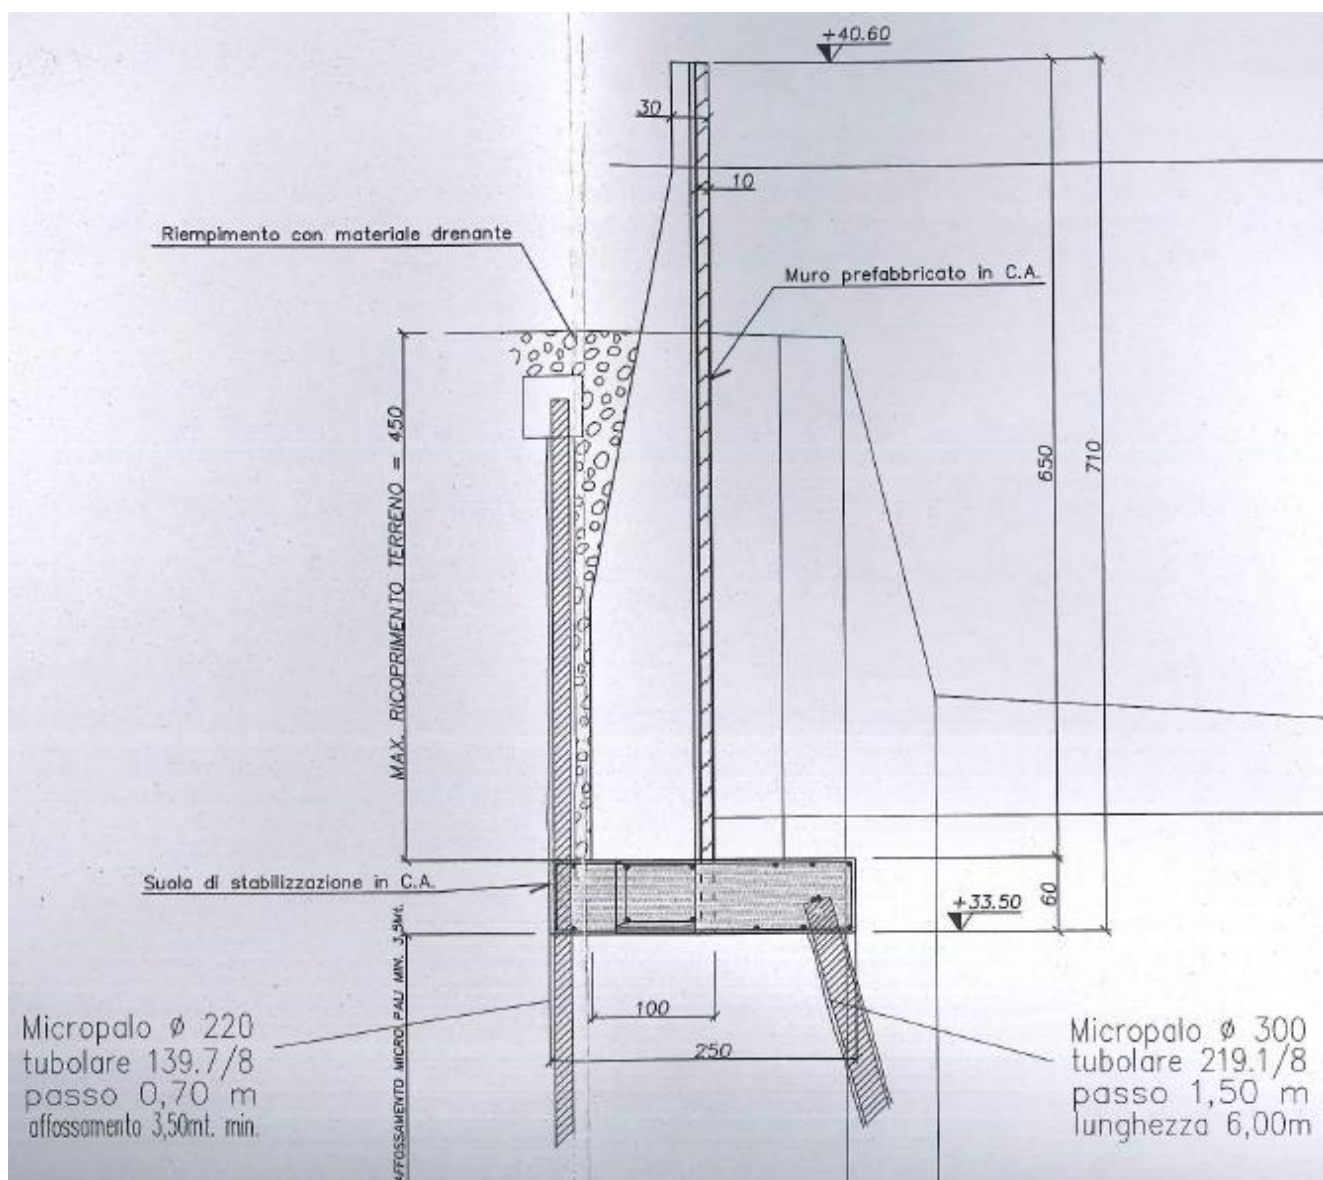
Sezione Muro tipo “A” - Estratto Pratica Sismica N. 613/2009
